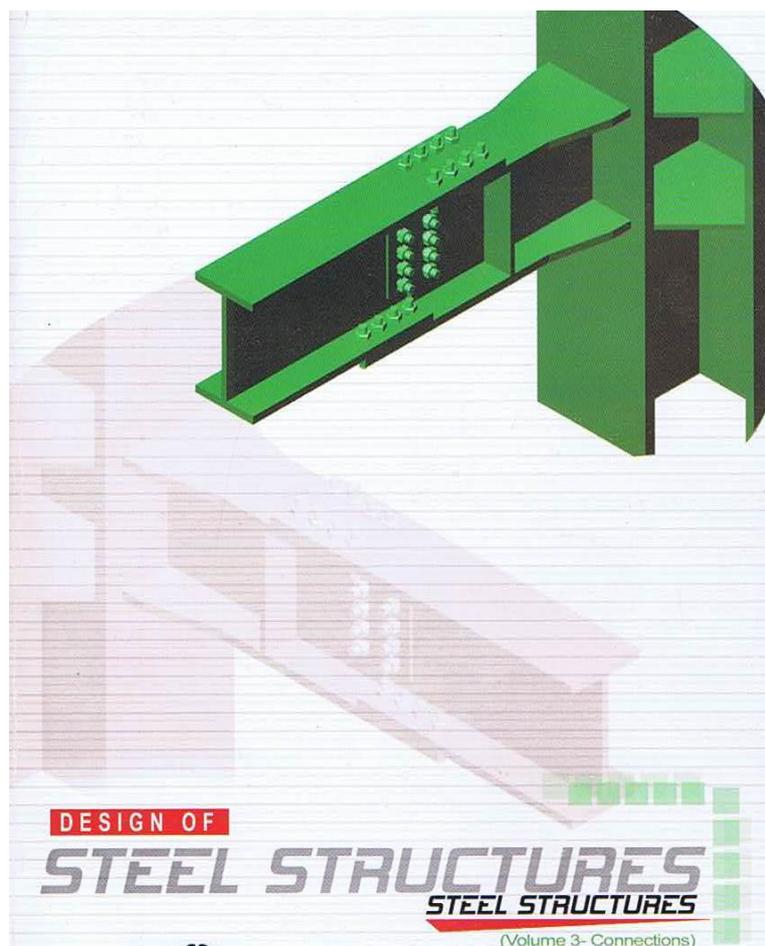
Standardwerk für Stahlbau-Anschlüsse
